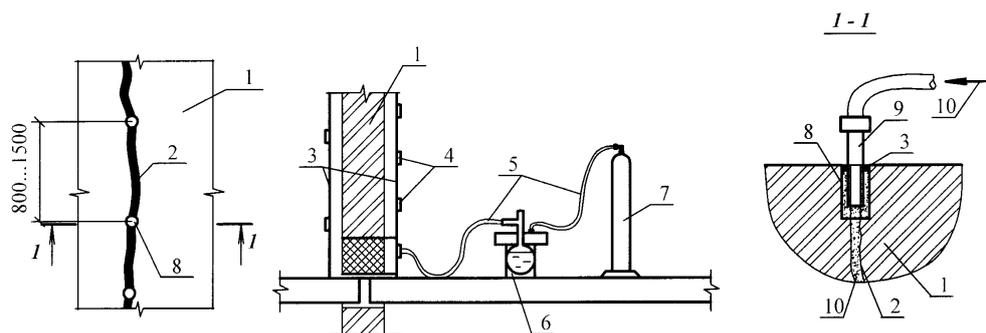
Схема инъектирования трещин в кладке шириной до 10 мм: 1 – усиливаемая стена; 2 – трещина; 3 – герметизация (накля на клею); 4 – шайбы; 5 – шланг; 6 – инъекционное устройство; 7 – баллон со сжатым воздухом; 8 – отверстия диаметром 30 мм для установки инъекторов; 9 – инъекторы; 10 – инъекционный состав
